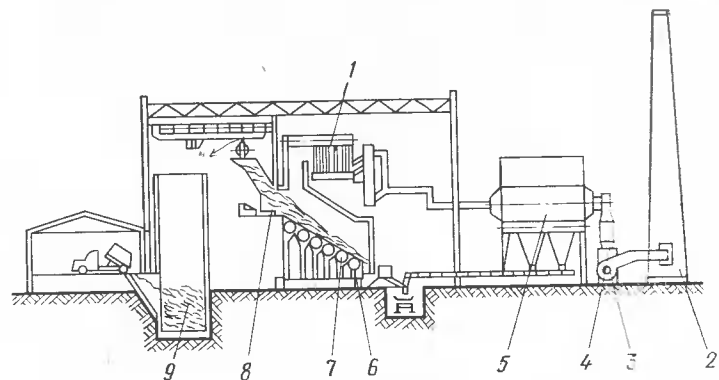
Мусоросжигательный котлоагрегат с валковой колосниковой решеткой
